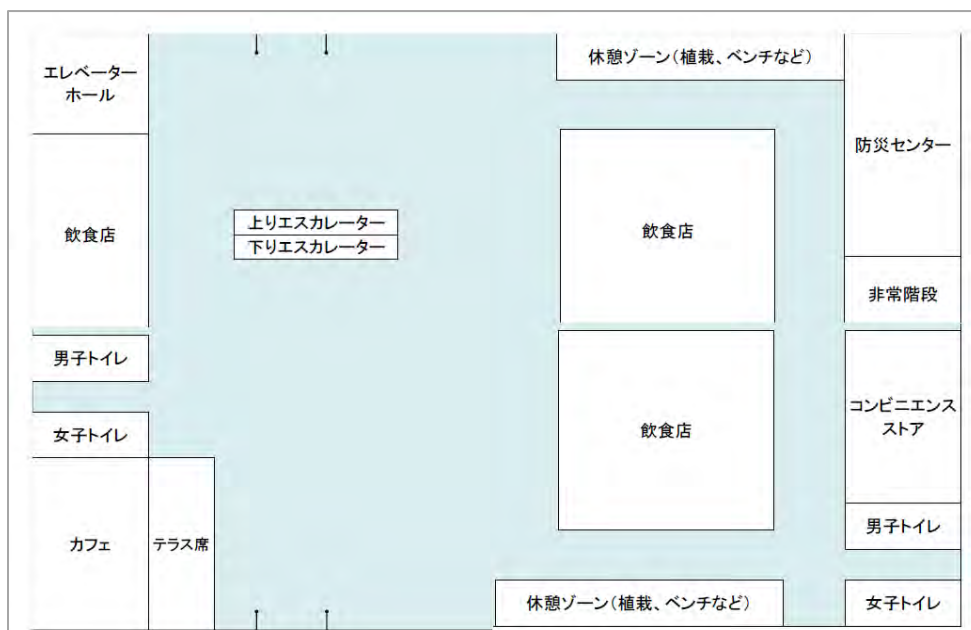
施設平面図 (縮尺 1/50), 廣井ほか (2011)
